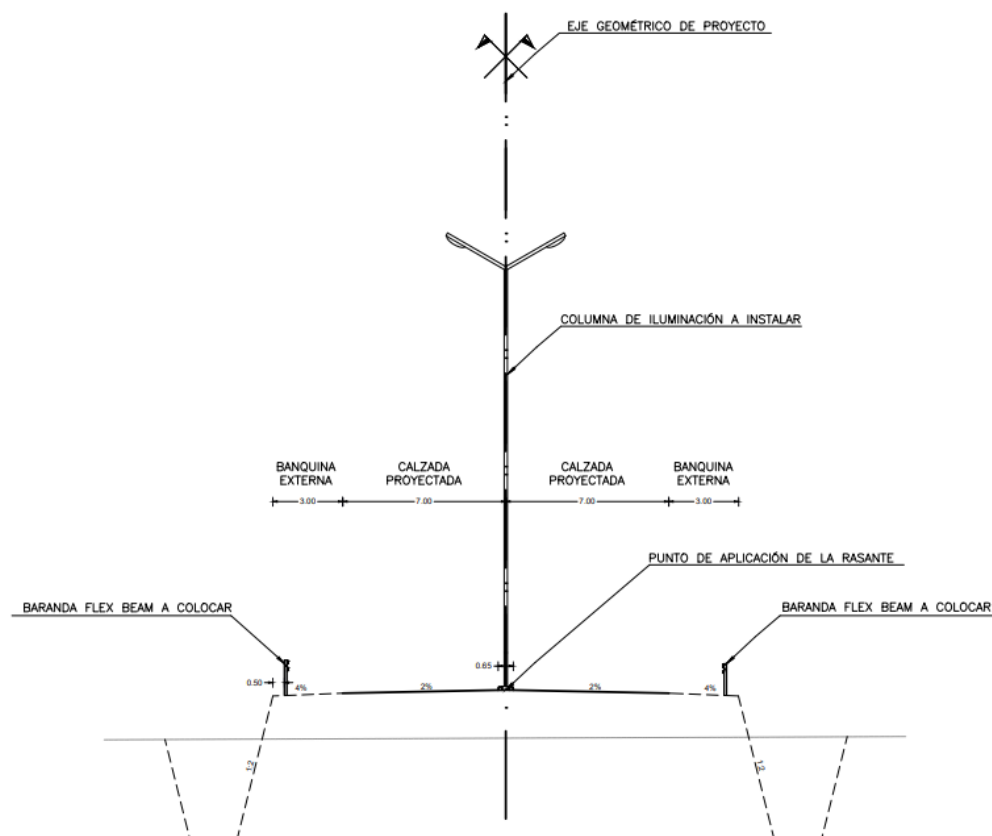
Perfil de obra básica de la Calle 143. Fuente: elaboración propia.
